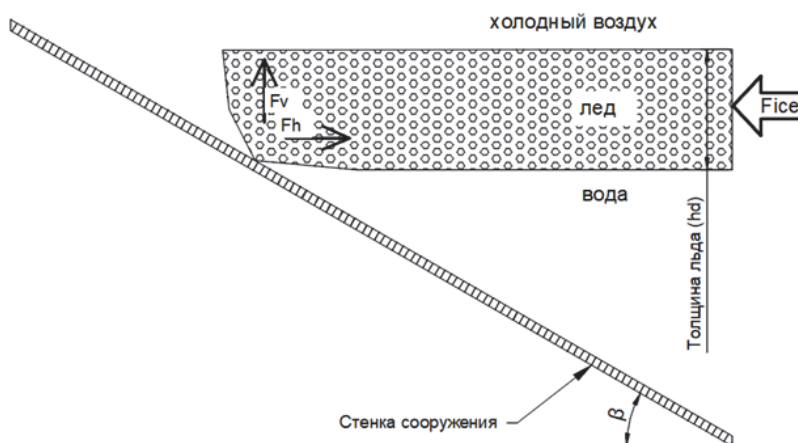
Схема нагрузок от ровного льда на наклонную конструкцию
